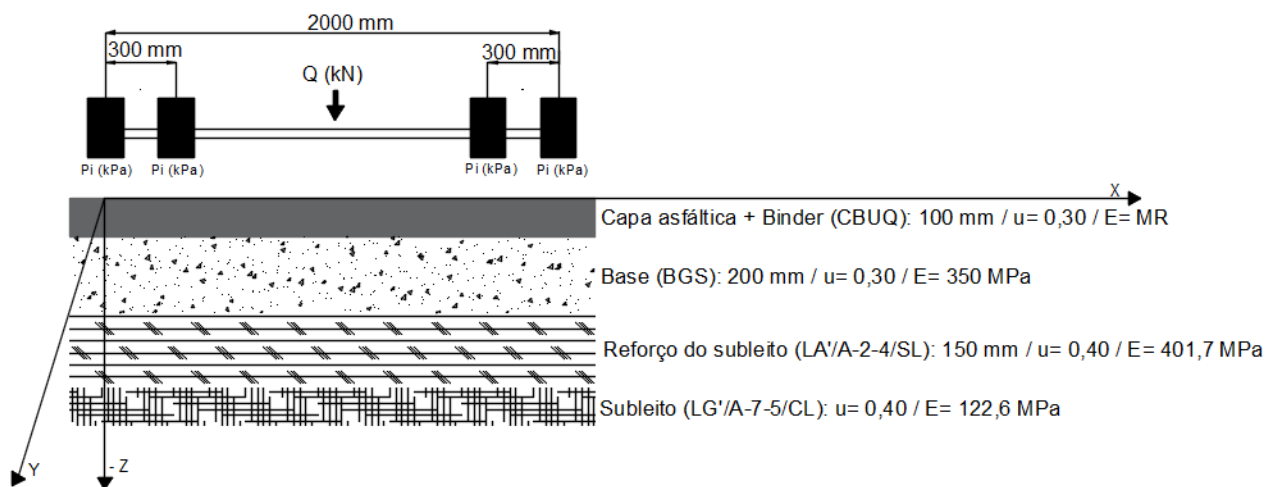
Esquema da seção transversal do pavimento-tipo adotado nas análises estruturais.
